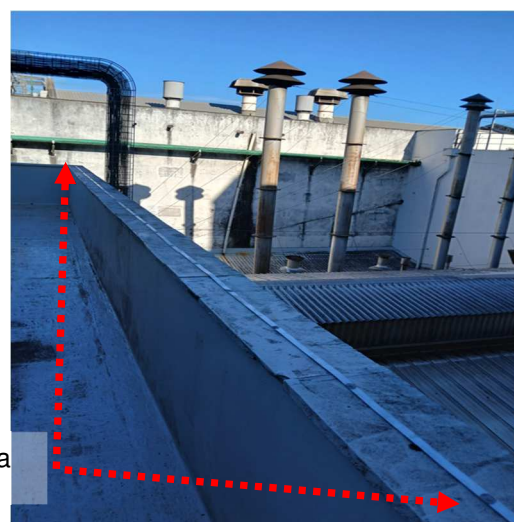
e 19: Interligação construída em desnível da altura da malha captora.
